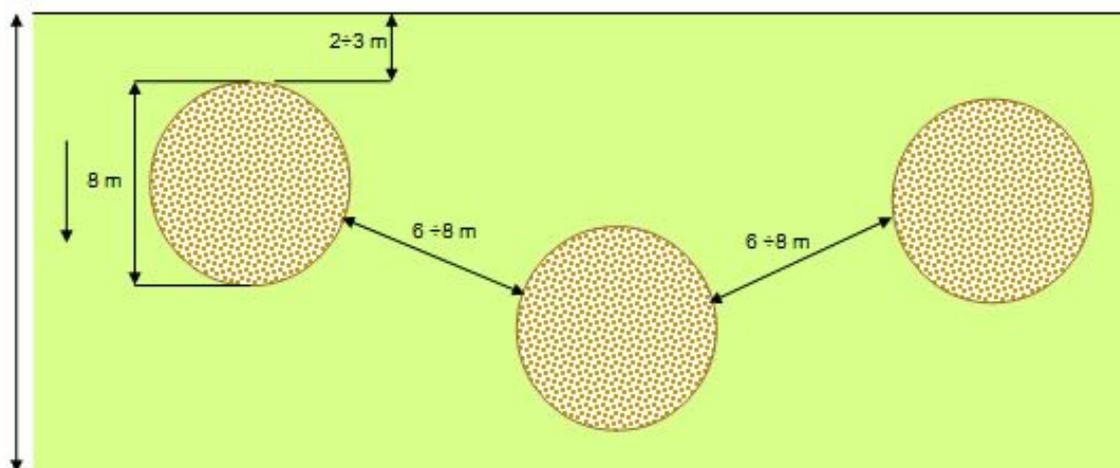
Schema della disposizione planimetrica delle isole vegetazionali all'interno della pista di lavoro.
